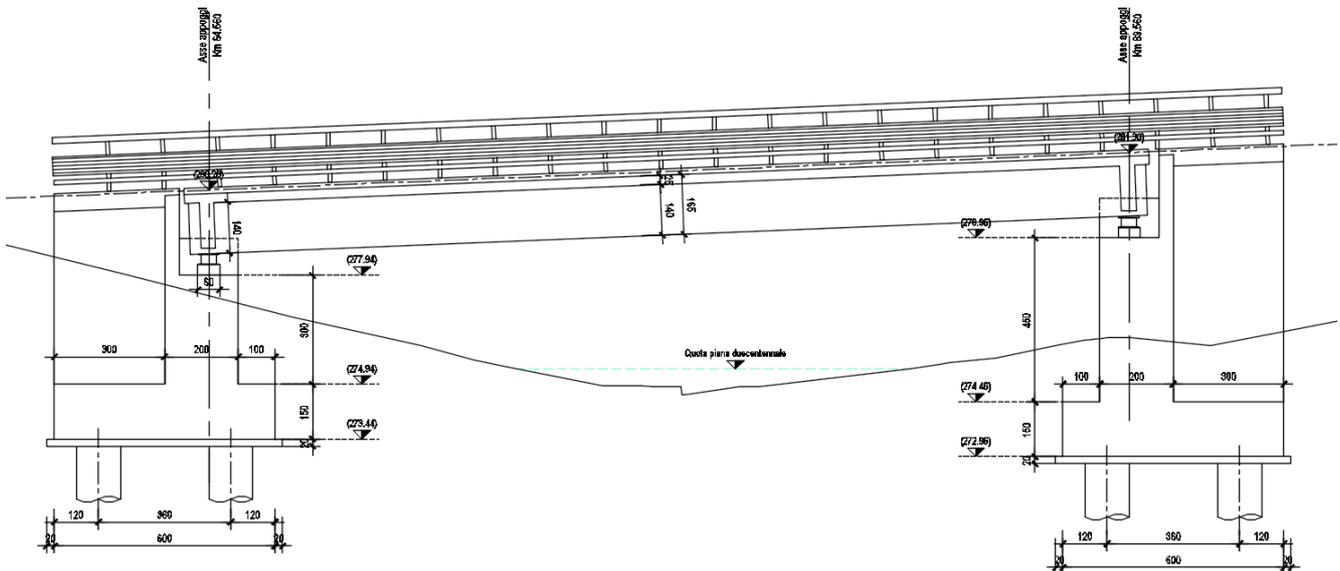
Ponte inizio lotto (pk 0+064.56) – Sezione longitudinale
